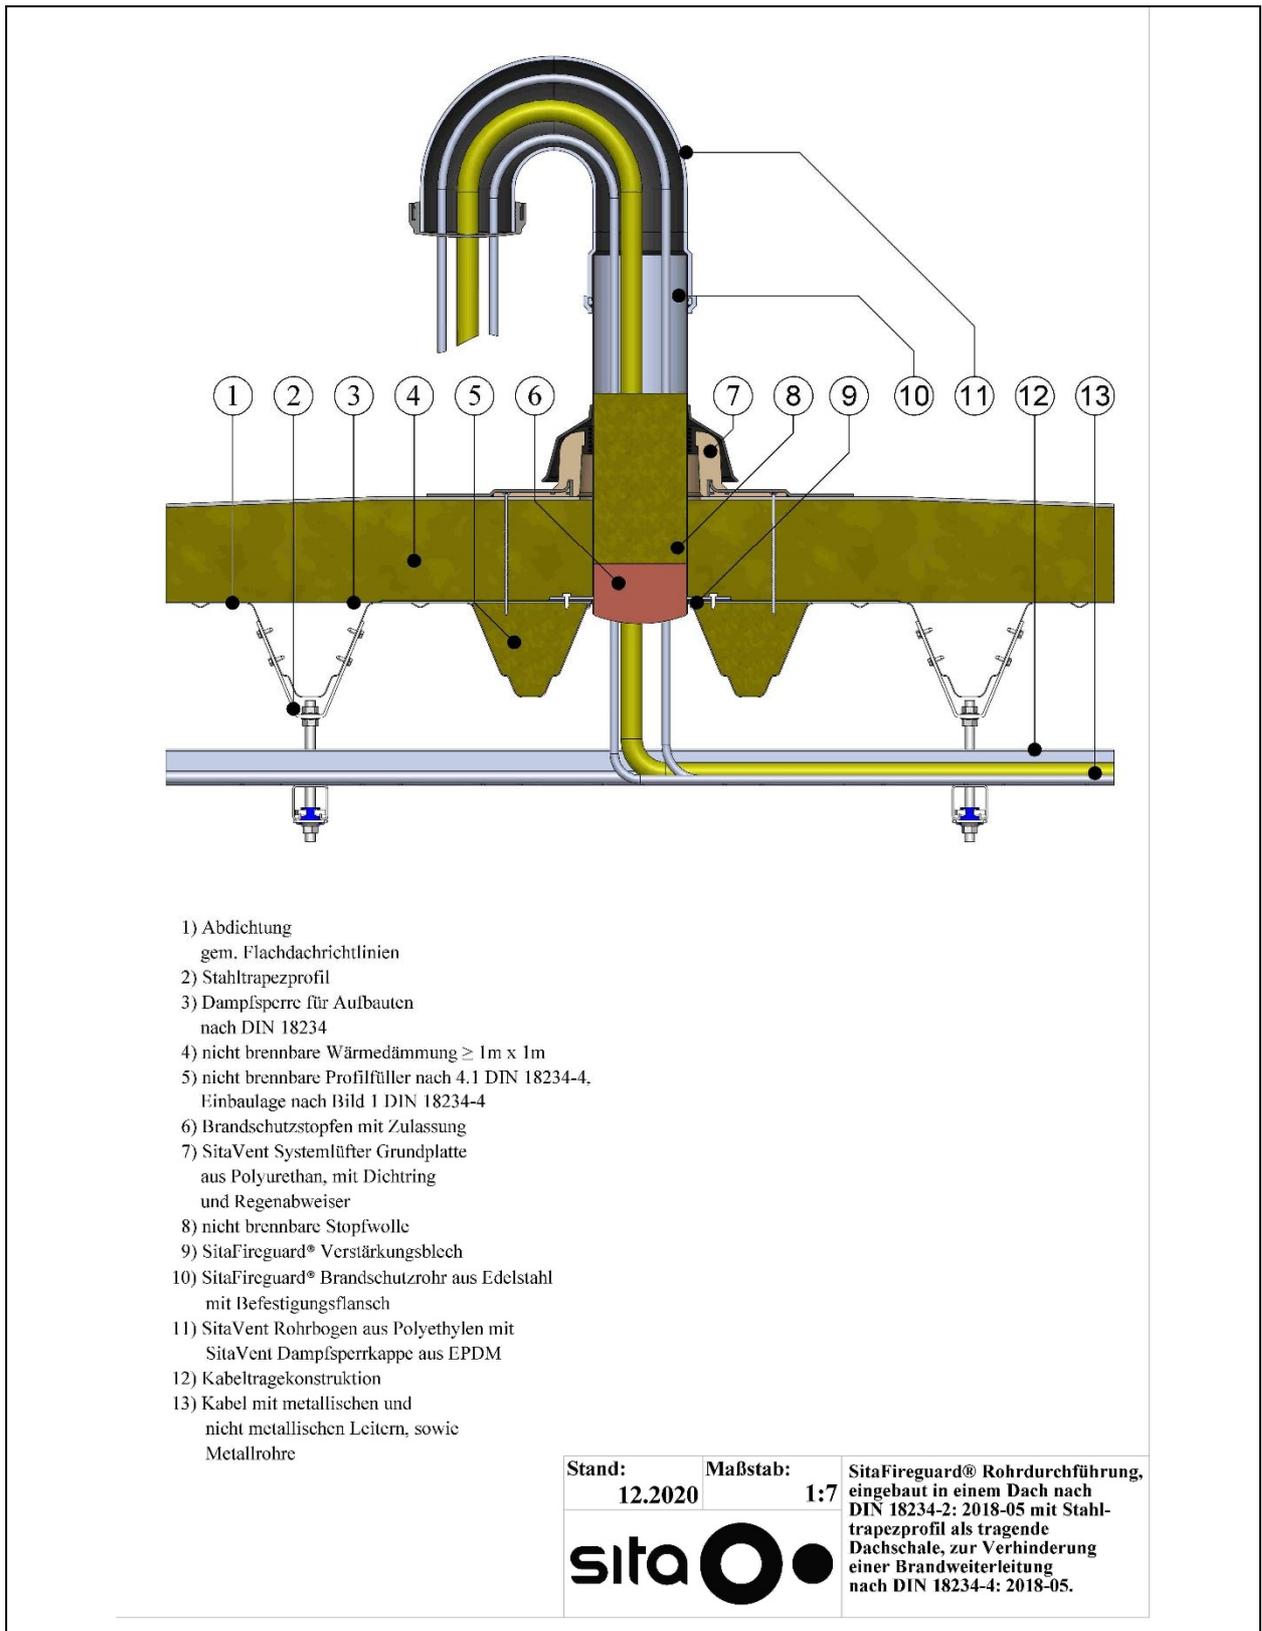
SitaFireguard® Rohrdurchführung Einbausituation in einem Dach DIN 18234-2
